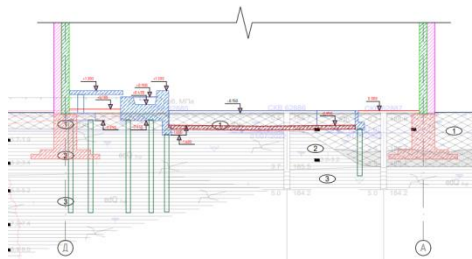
Поперечный разрез промышленного железобетонного каркаса с указанием встраиваемых объектов в эксплуатируемое сооружение.
